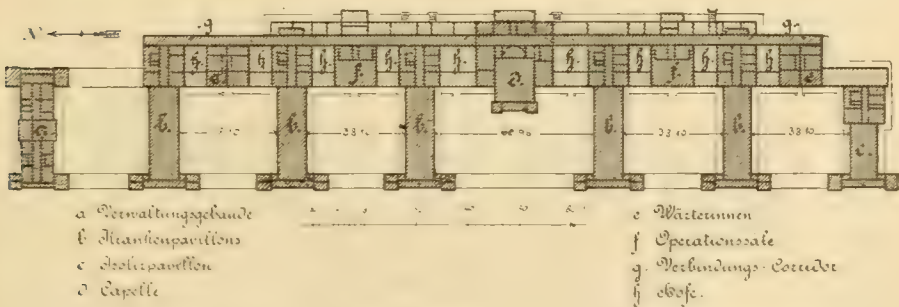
St. Thomas-Hospital in London. Lageplan.
